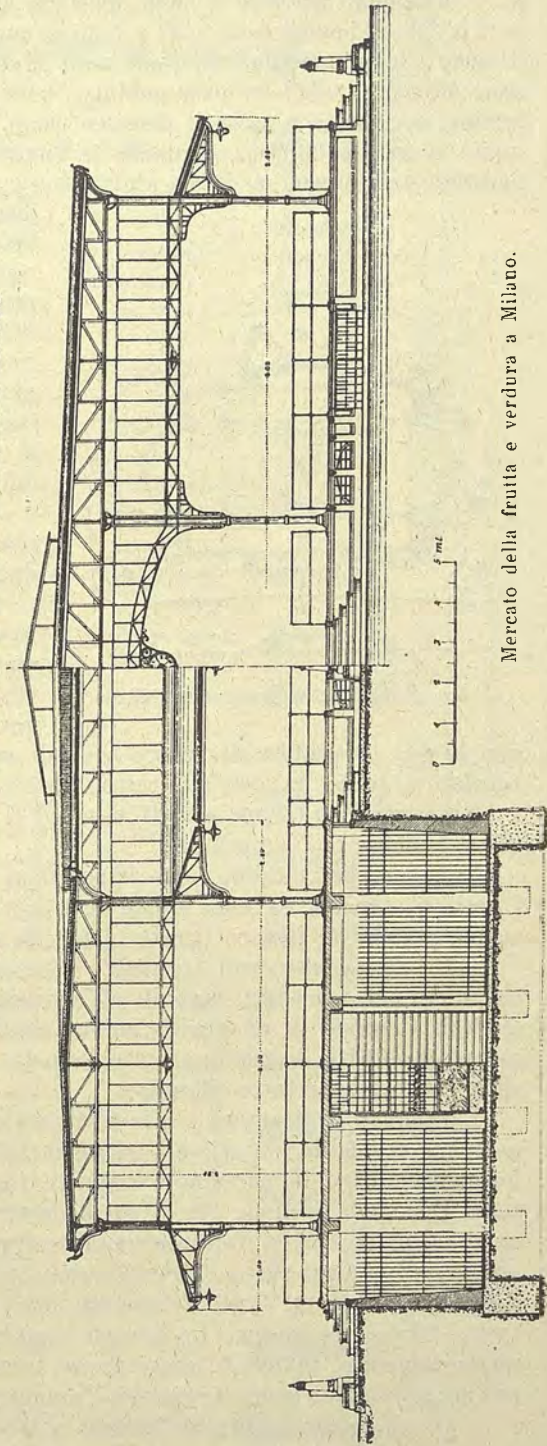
f. — Mezza sezione trasversale e mezza testata delle tettoie centrali.
